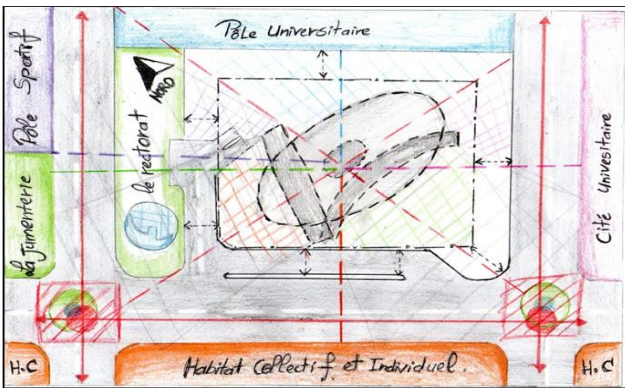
la jonction des volumes sur le plan planimétrique source :auteur
